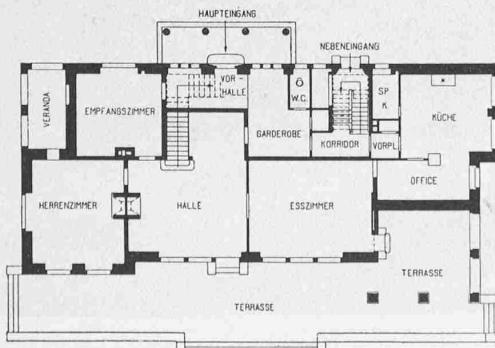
und 4. Grundrisse des Hauses Rammersbühl. — 1:400
